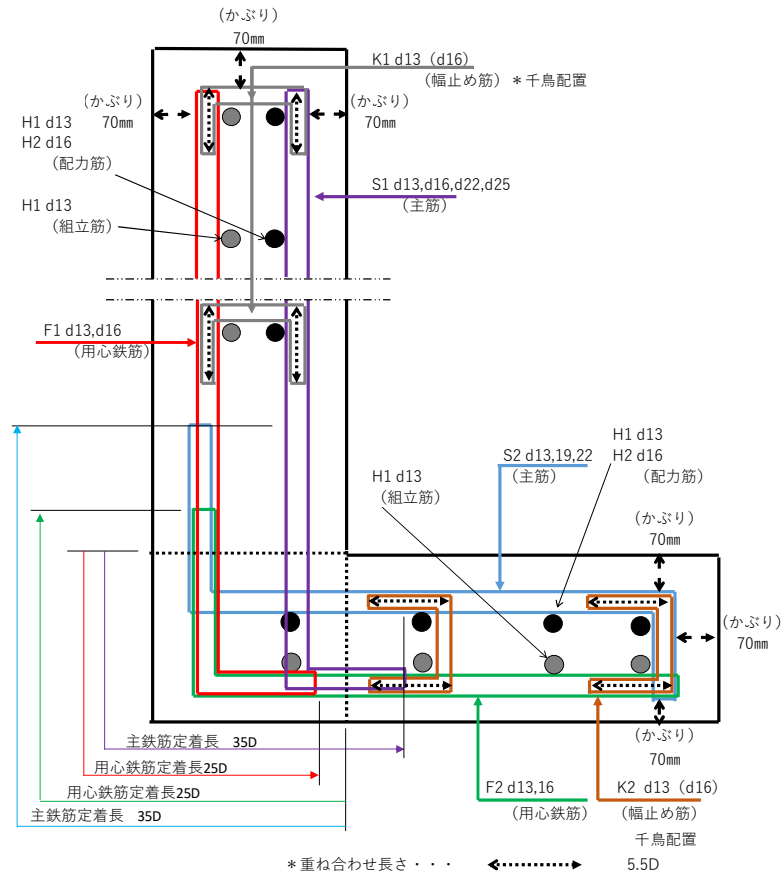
L型鉄筋コンクリート擁壁縦壁基部の配筋要領図
